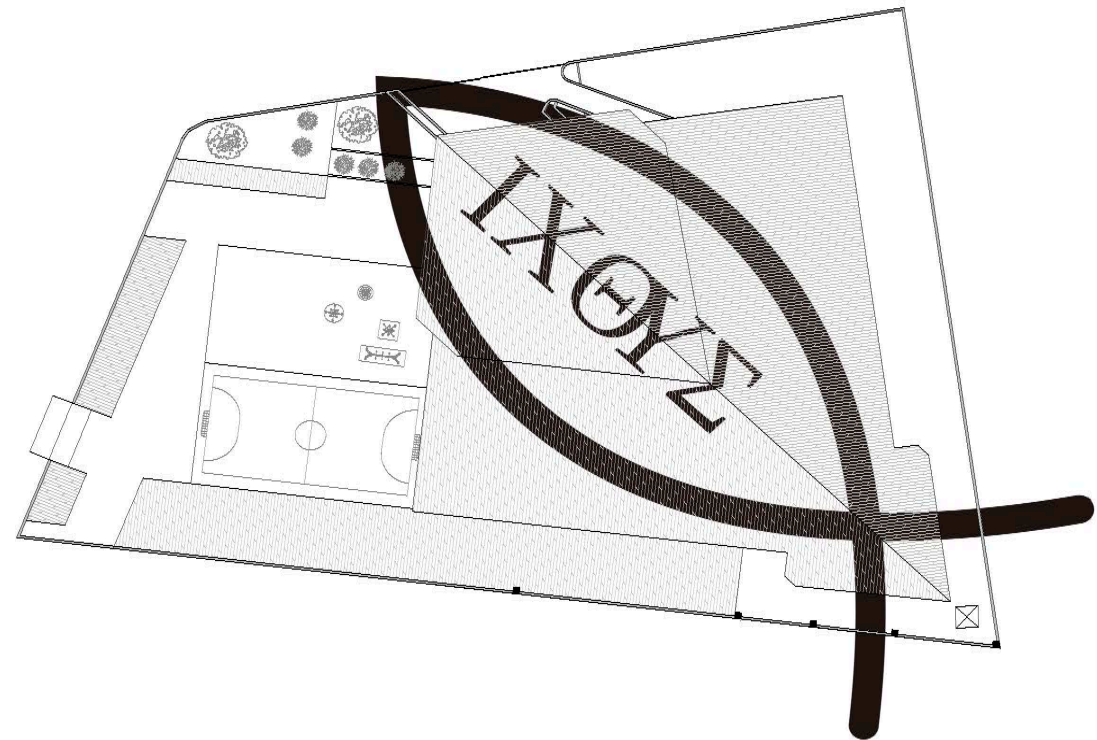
Planta de cubiertas , Templo Centro cristiano
